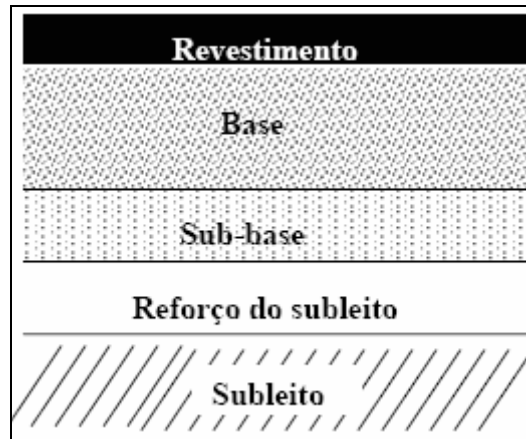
Estrutura do pavimento de uma rodovia [SÁ, 2003]
